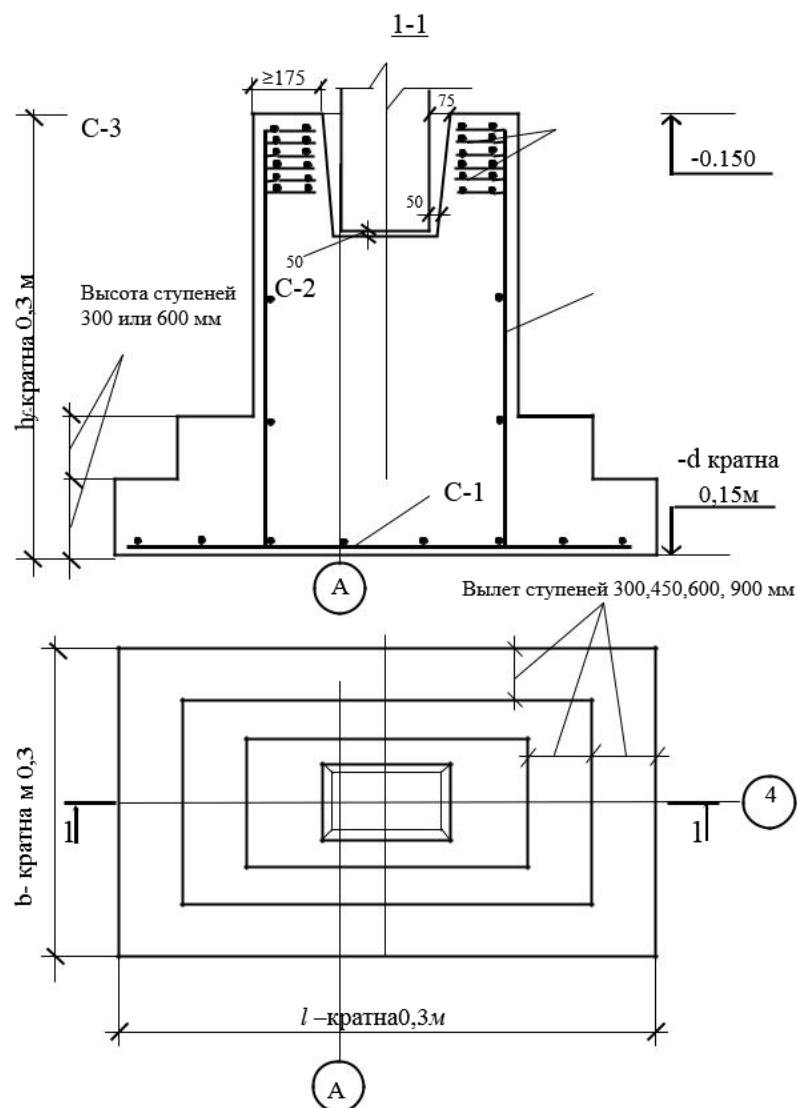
Столбчатый фундамент под крайнюю рядовую колонну
